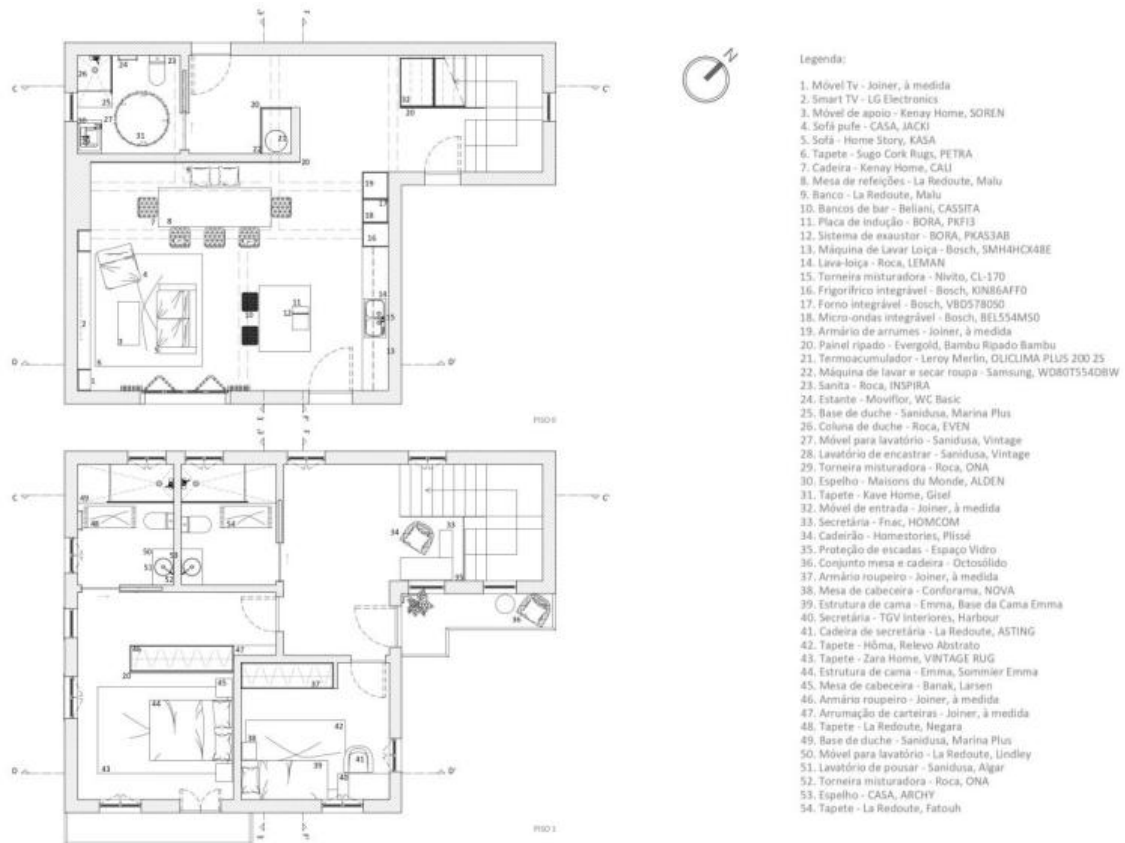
Planta de Equipamento e Mobiliário, Piso 0 e Piso 1. Fonte: Autor
